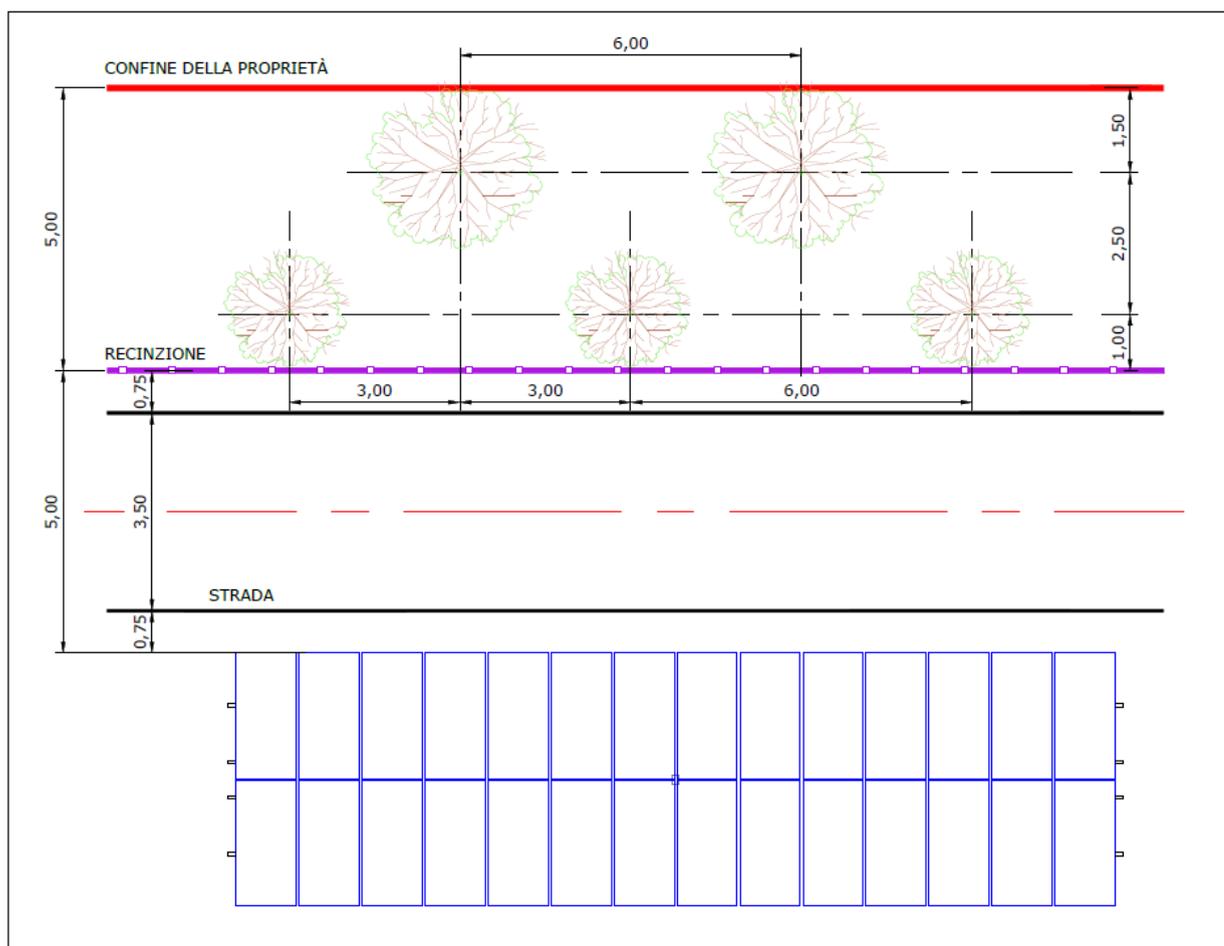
fascia di piantumazione / mitigazione vista in pianta
